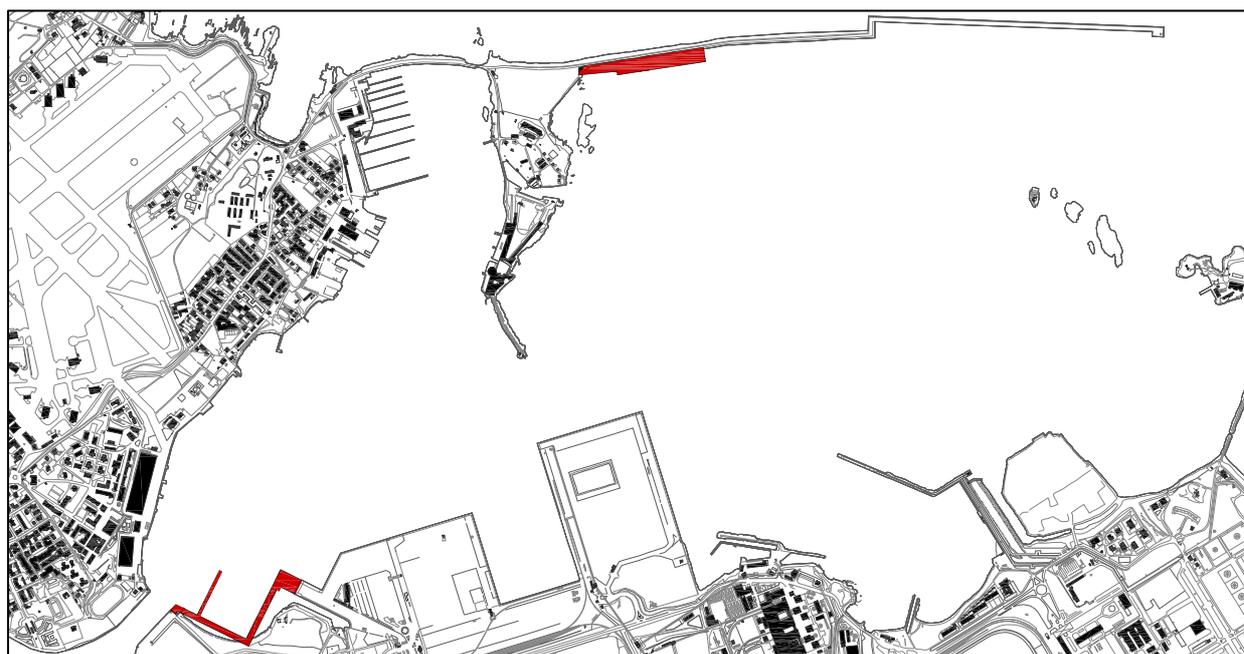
Ubicazione planimetrica interventi di Adeguamento Tecnico Funzionale
